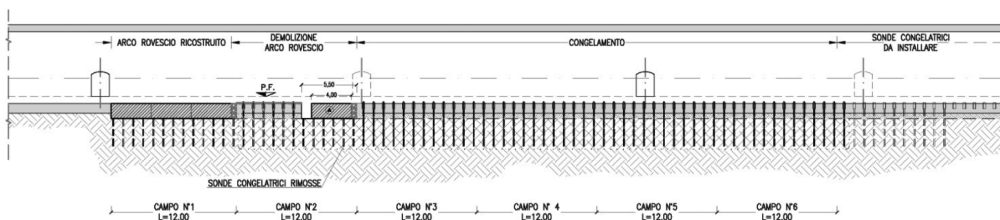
La sequenza di demolizione e ricostruzione dell'arco rovescio. *The stages of tunnel invert reconstruction.
